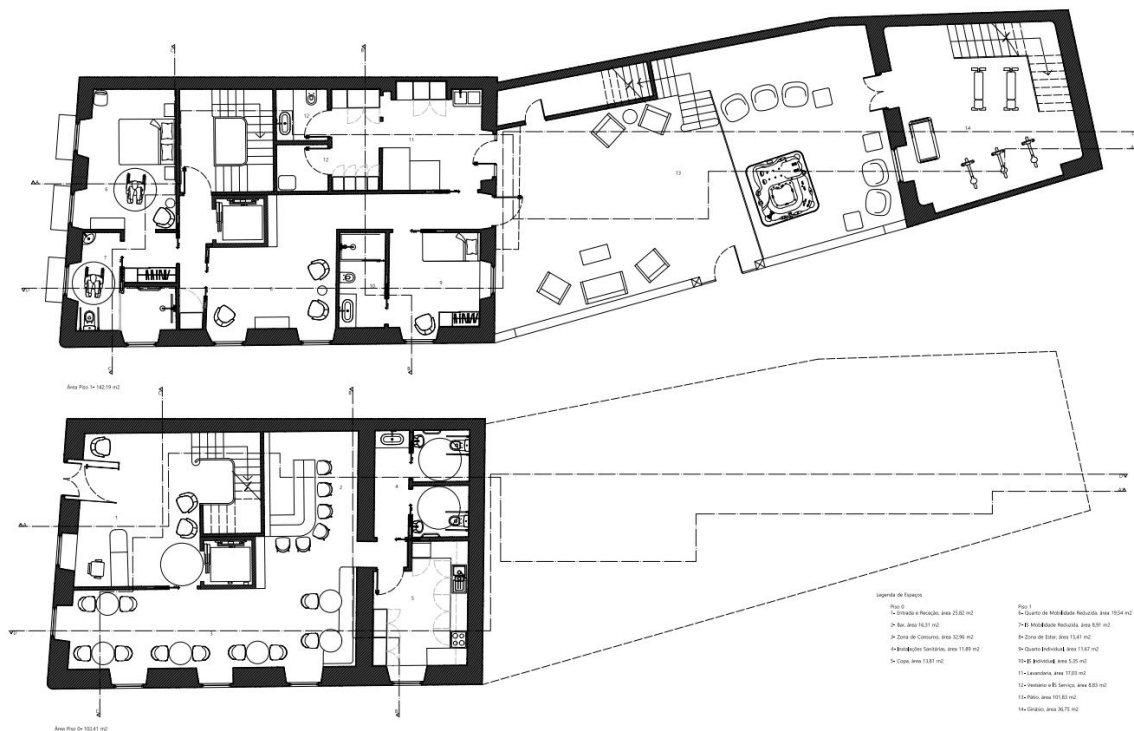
Planta de proposta - Piso 0 e Piso 1
